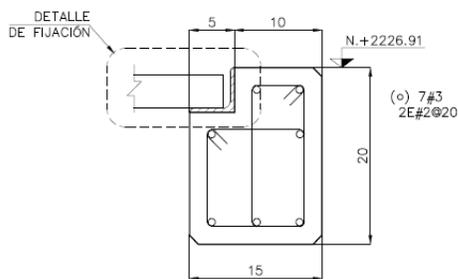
Detalle de sección de dalas superiores tipo D-2.
